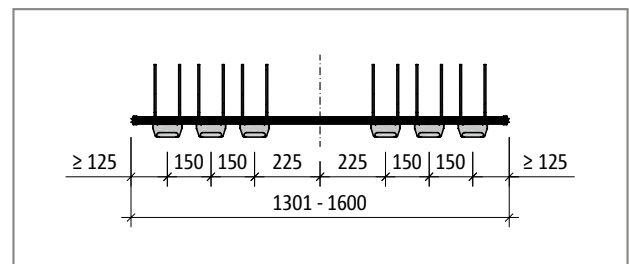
Schöck Tronsole® Typ T-V6-H...-L1301 bis L1600: Produktgrundriss
